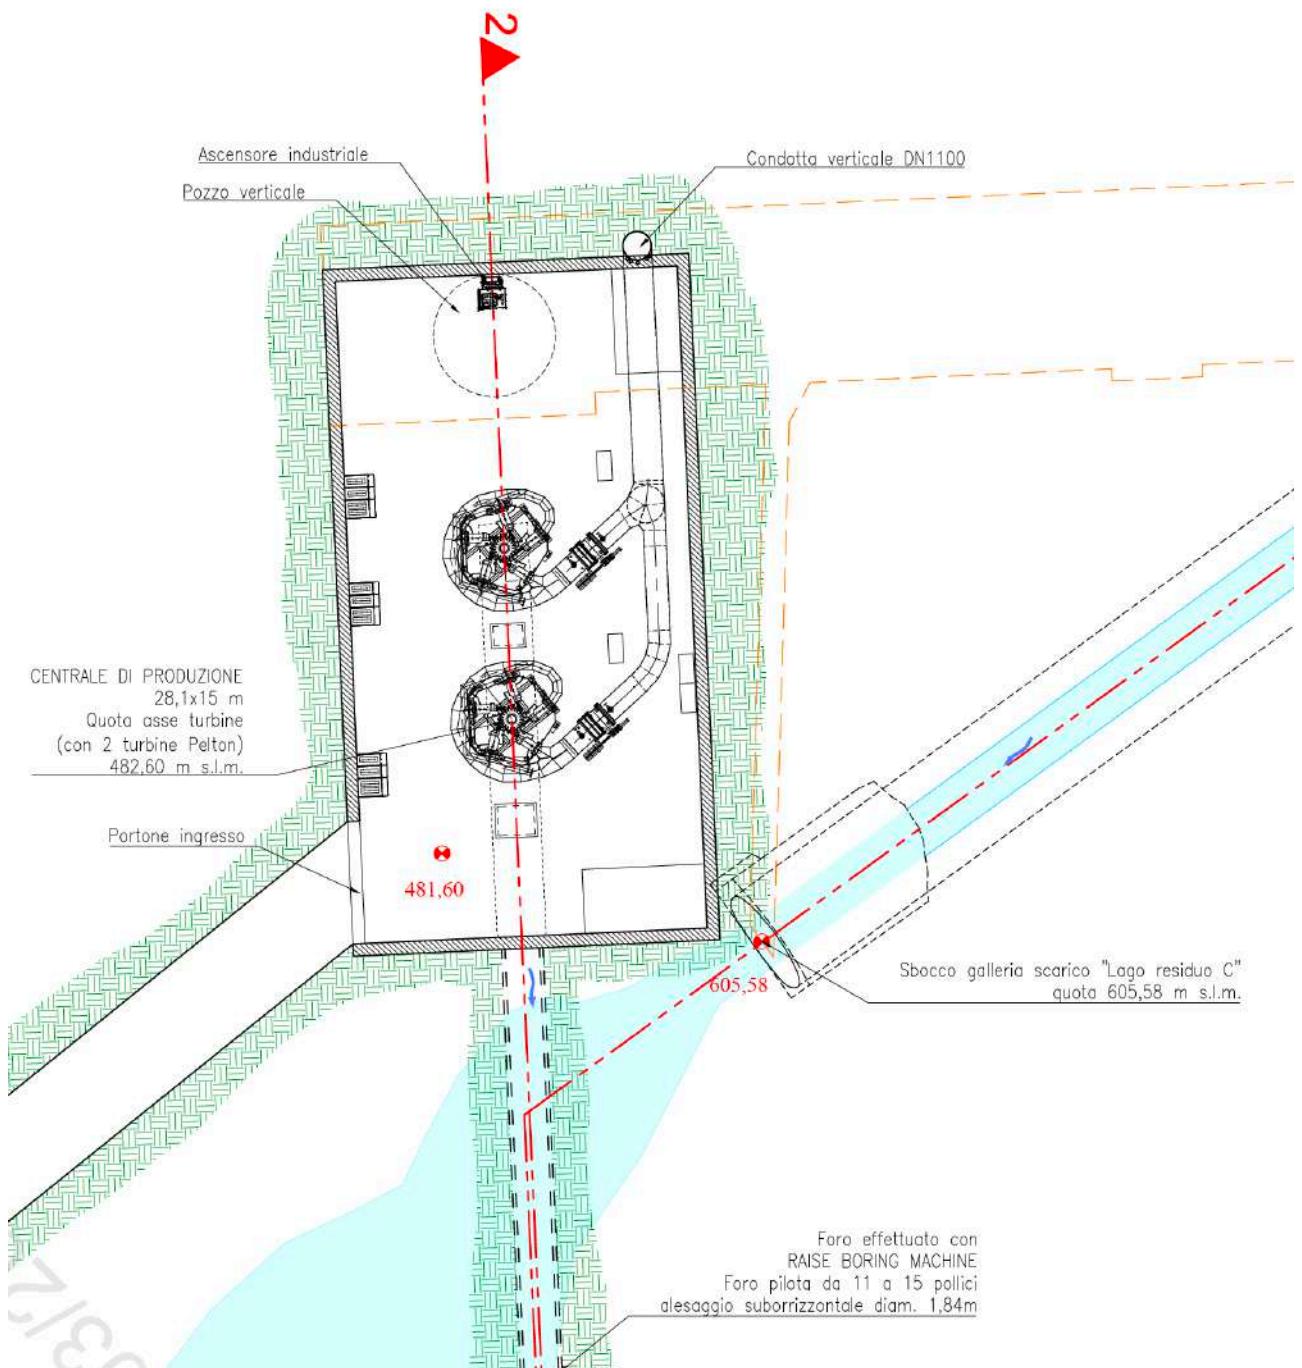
Pianta dell'edificio centrale: si può notare il pozzo verticale di accesso all'edificio ($D = 5\text{ m}$), il pozzo della condotta forzata DN1100, la condotta di scarico e la galleria di accesso.
